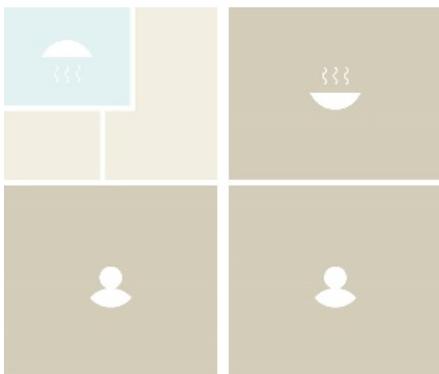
Schema Grundriss 2er WG (Architekt Schweizer)
